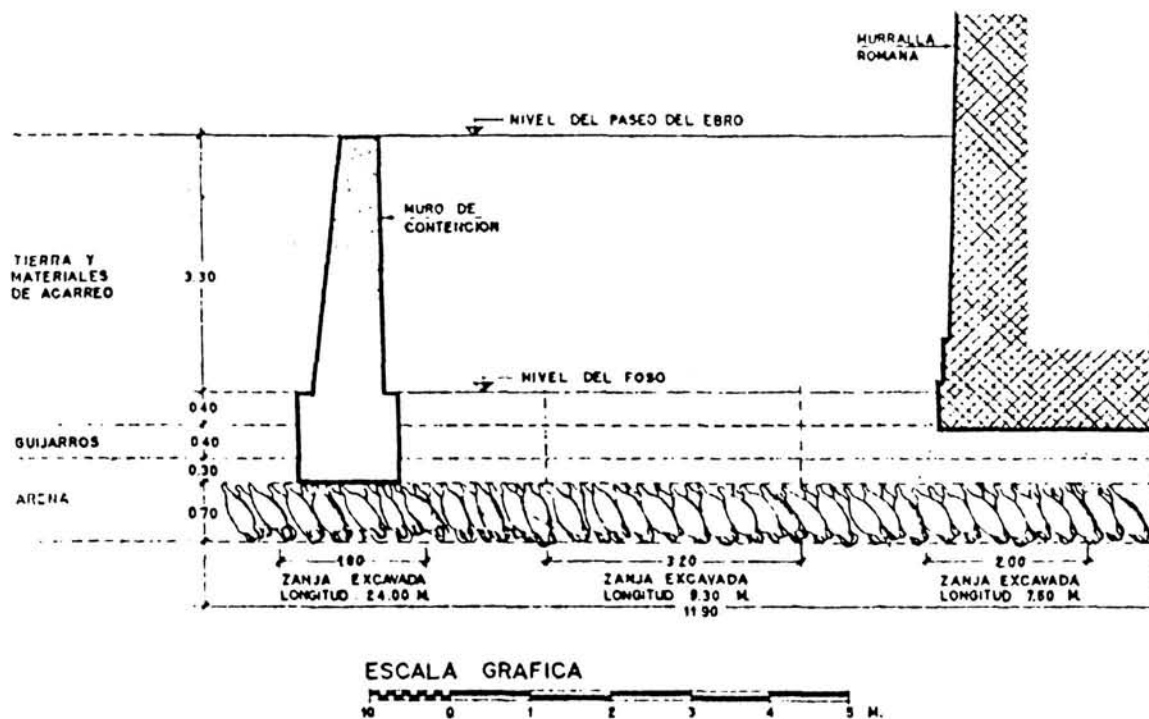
Sección de la excavación de la muralla del Santo Sepulcro (según F. Iniguez).
